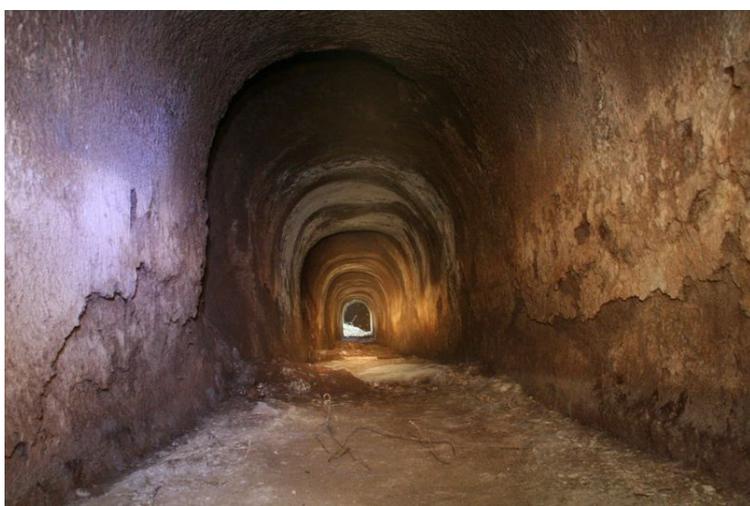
La lunga galleria in direzione del c.d. Grande Trapezio.
